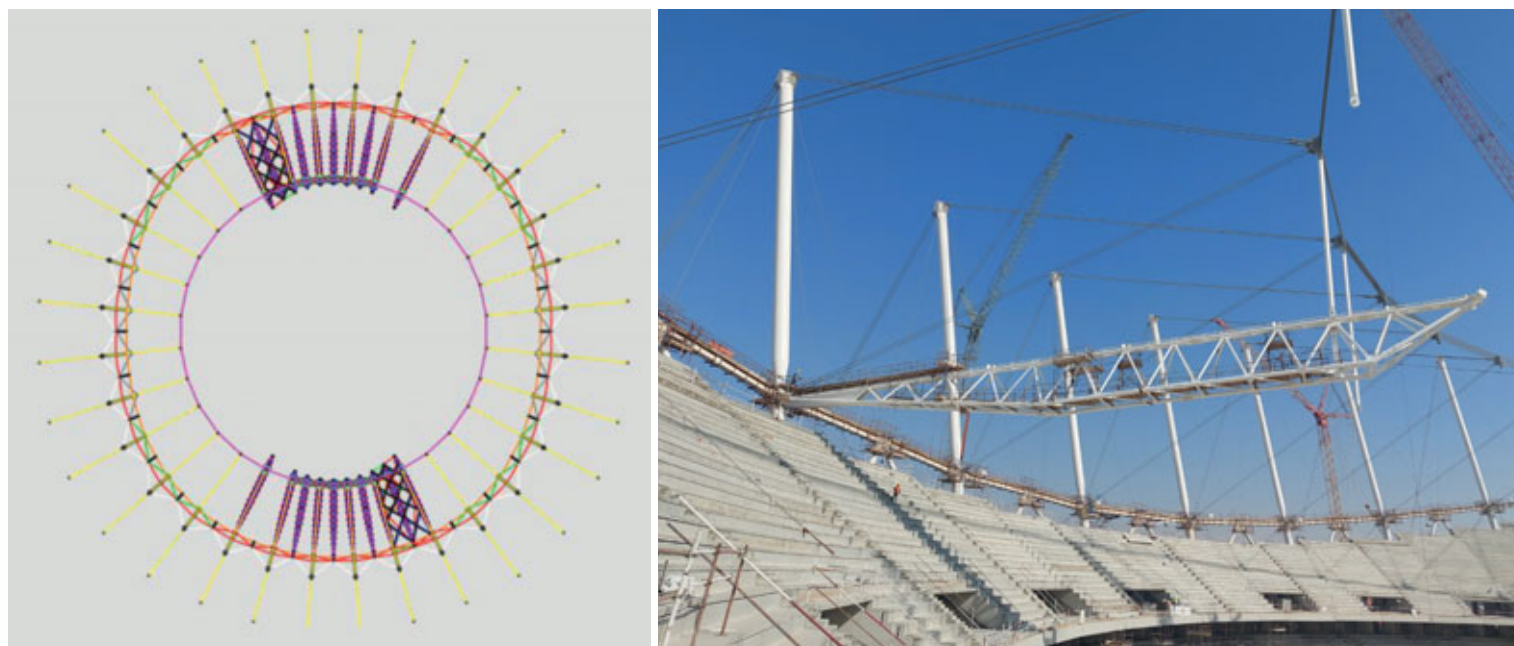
Simulazione numerica e immagine dal cantiere dell'installazione delle travi radiali
